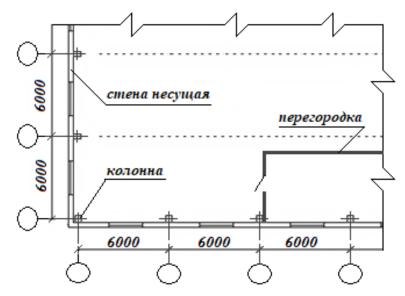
Изображение колонн, стен и перегородок на плане
